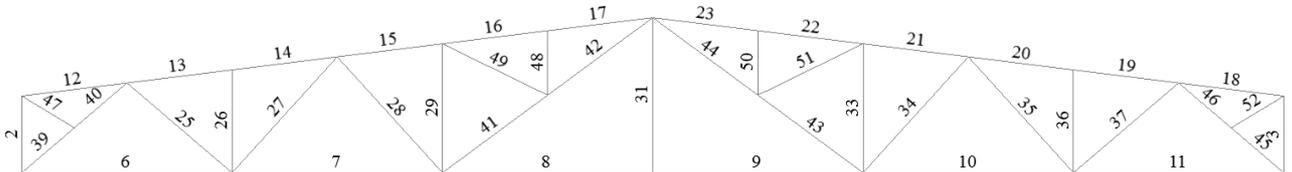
Схема стропильной фермы с номерами элементов
